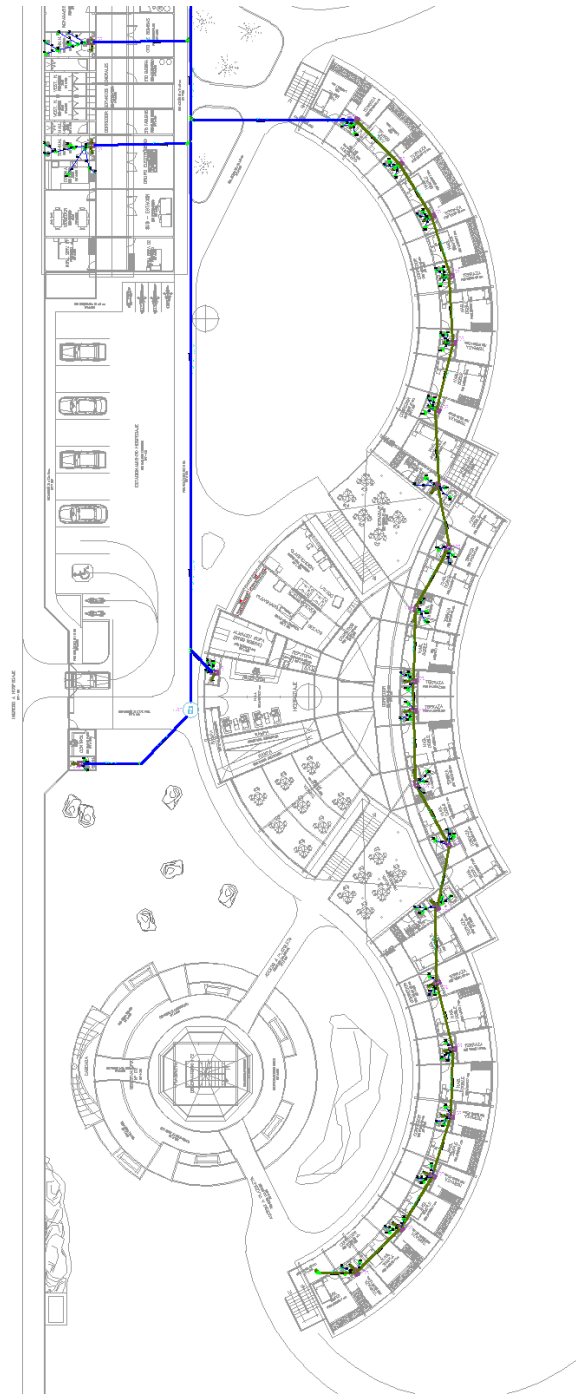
Plano de instalaciones sanitarias-desagüe bloque hospedaje
